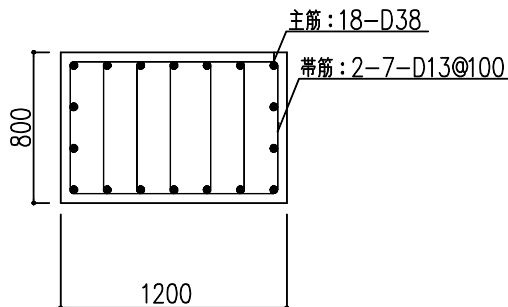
柱の配筋図 (地下2階, X3/YF 通り, 柱脚部) (単位: mm)
